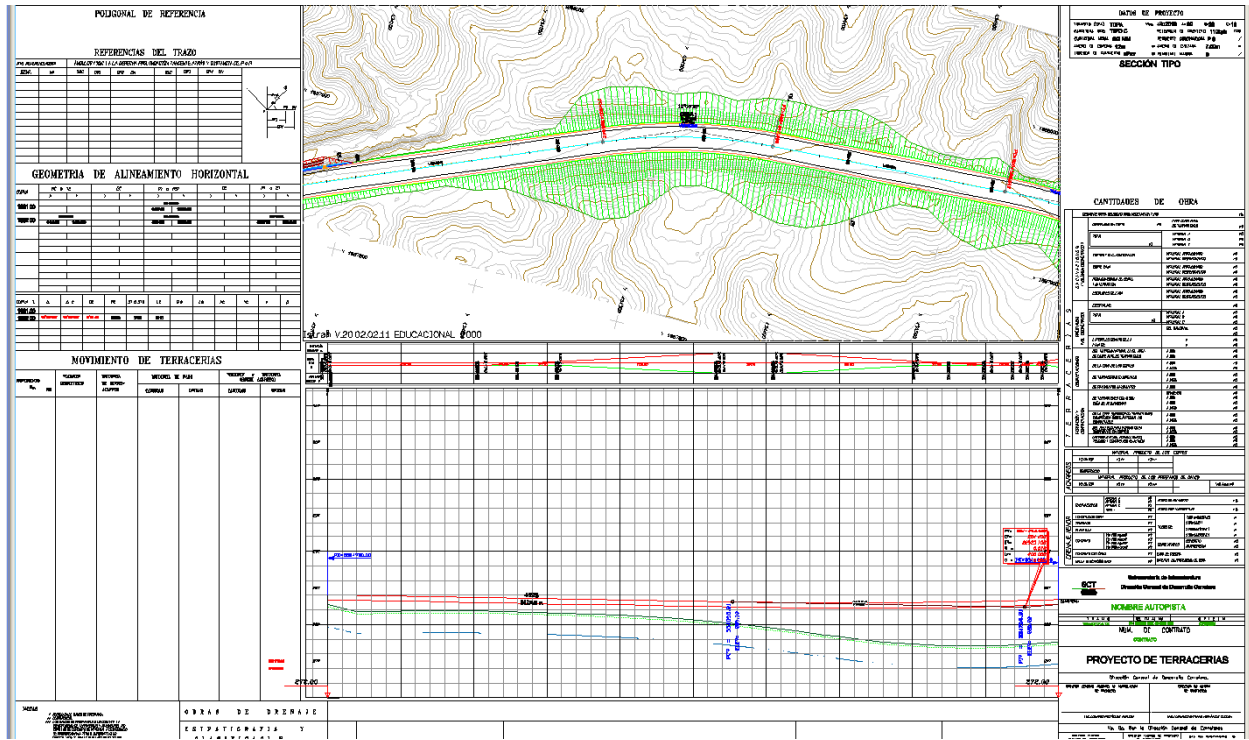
Planta Kilómetro generada por ISTRAM Fuente: Propia
